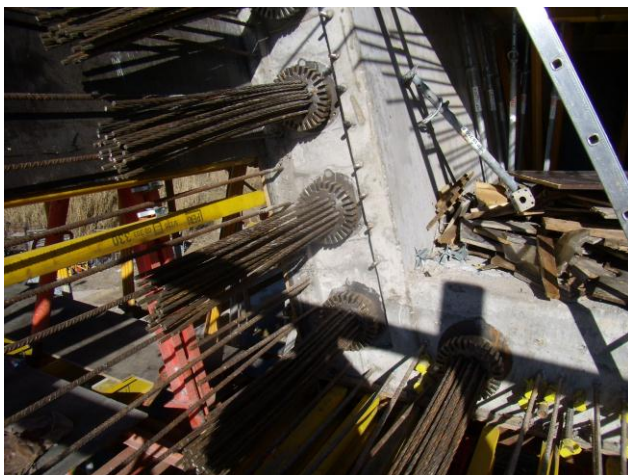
Vista de los acopladores para tendones de la siguiente fase constructiva.
